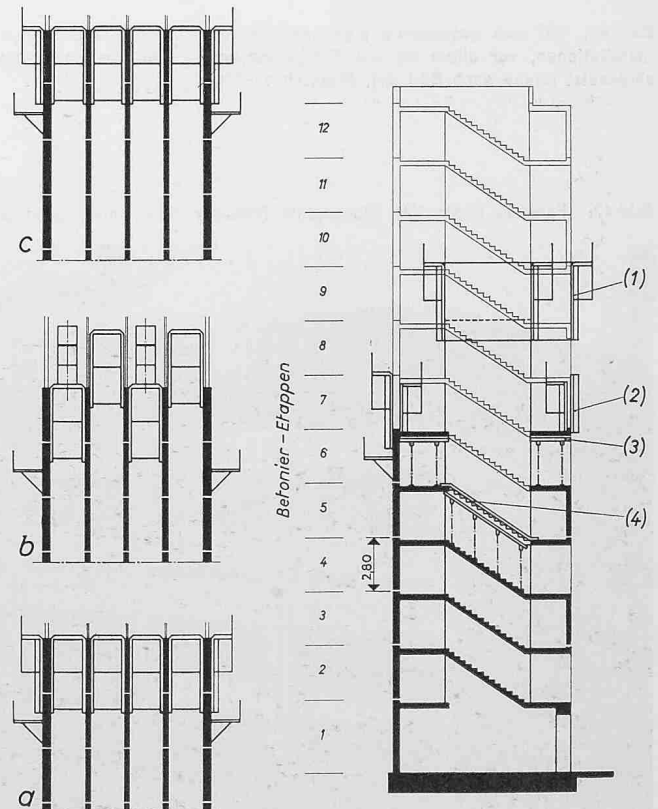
Zur Rationalisierung des Schalungssystems wurden besondere Steigschalungen und Steiggerüste angefertigt. Nähere Erklärung siehe im Text
